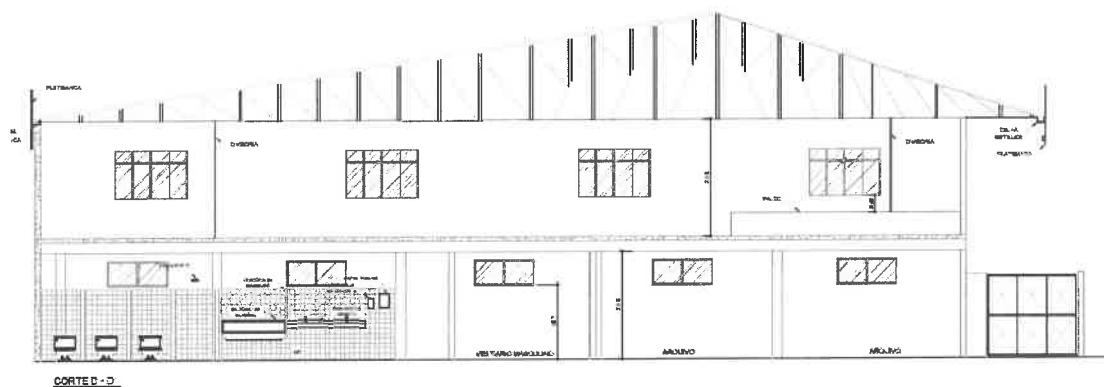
Corte Lateral da Planta da Sede da Cigás
